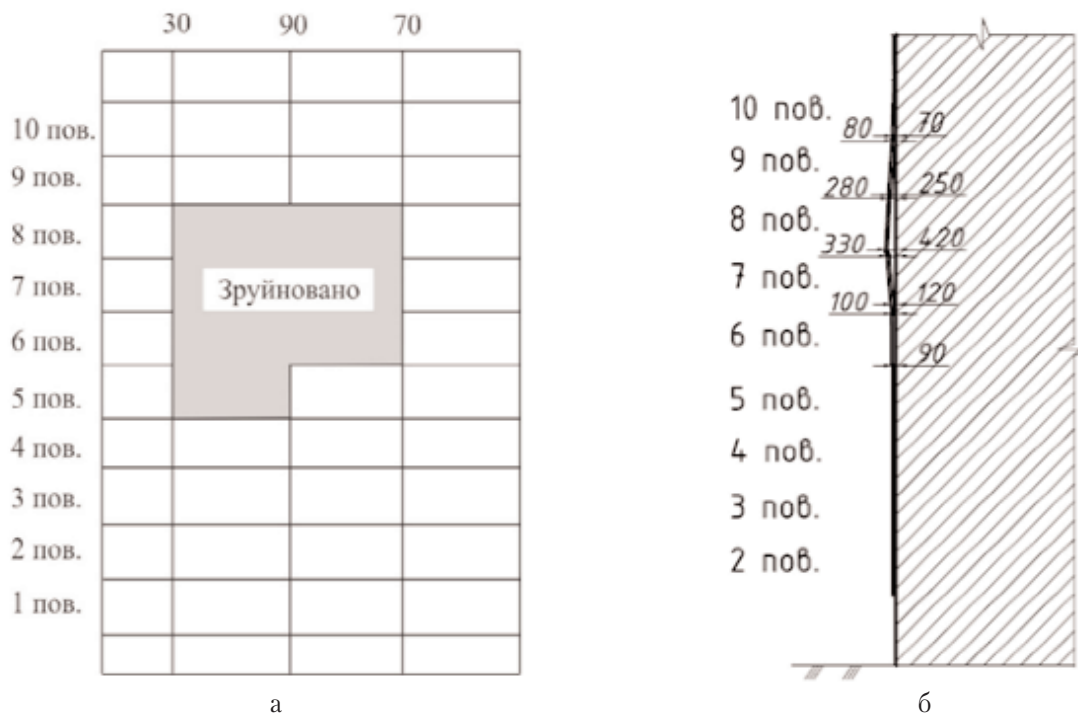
Деформації конструкцій пошкодженої секції будівлі з вул. Соломії Крушельницької, 1/5.
